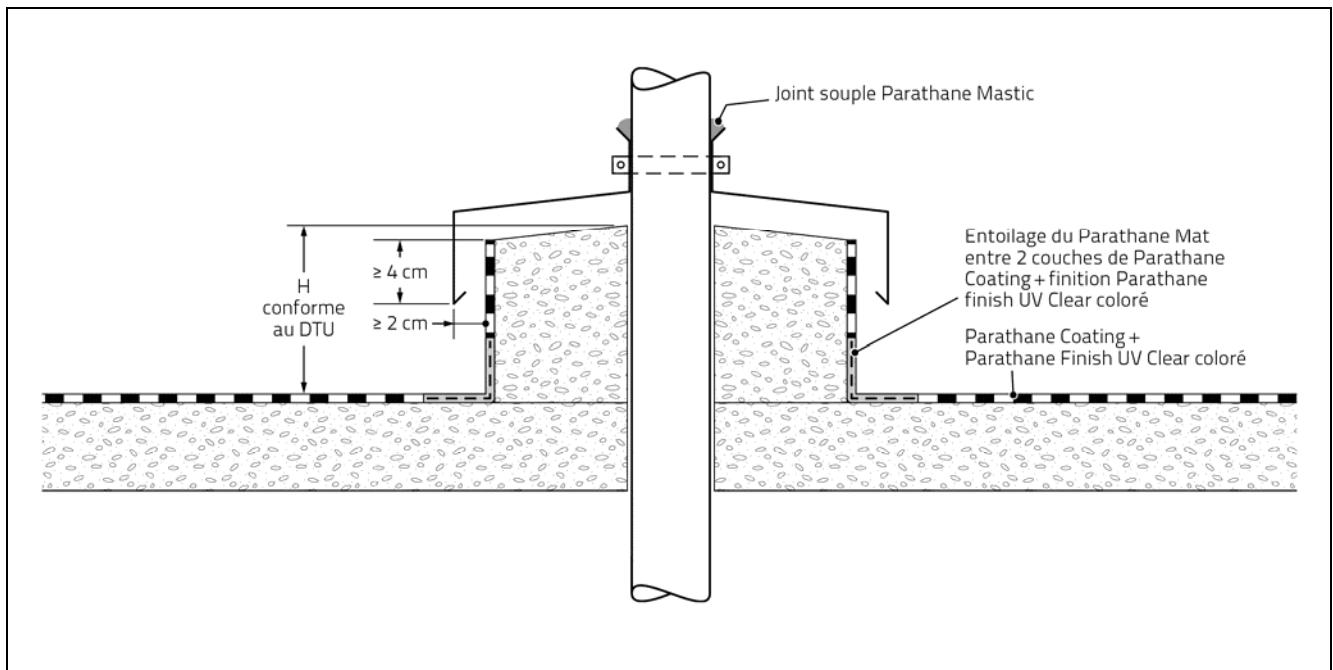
bis – Traversée de toitures accessible avec dé en béton
